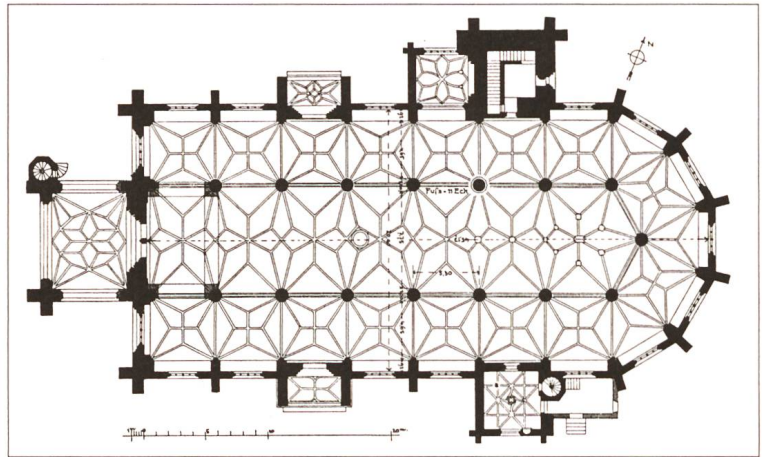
Grundriss der Spitalkirche Heilig Geist in Landshut.
